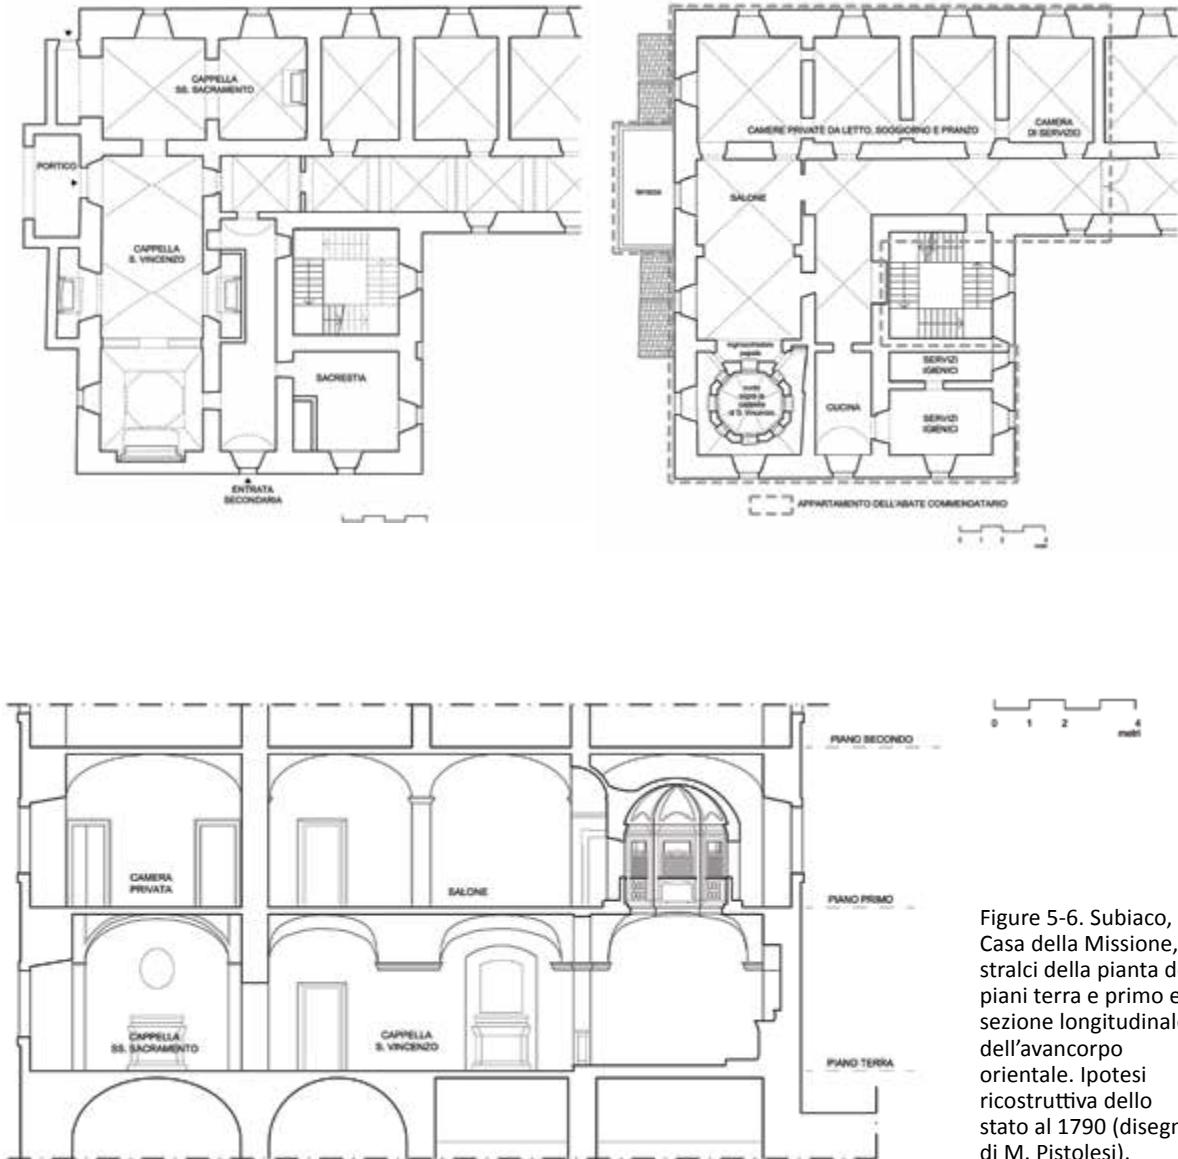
Subiaco, Casa della Missione, stralci della pianta dei piani terra e primo e sezione longitudinale dell'avancorpo orientale. Ipotesi ricostruttiva dello stato al 1790 (disegno di M. Pistolesi).
